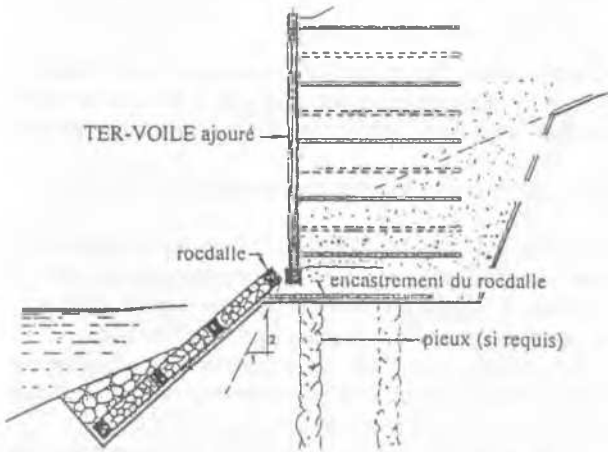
Rocdalle béton alvéolaire/TER-VOILE AJOURÉ-Coupe type
